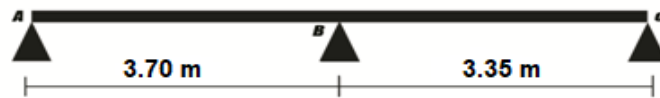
Schéma du 2^{eme} type de poutrelle.
